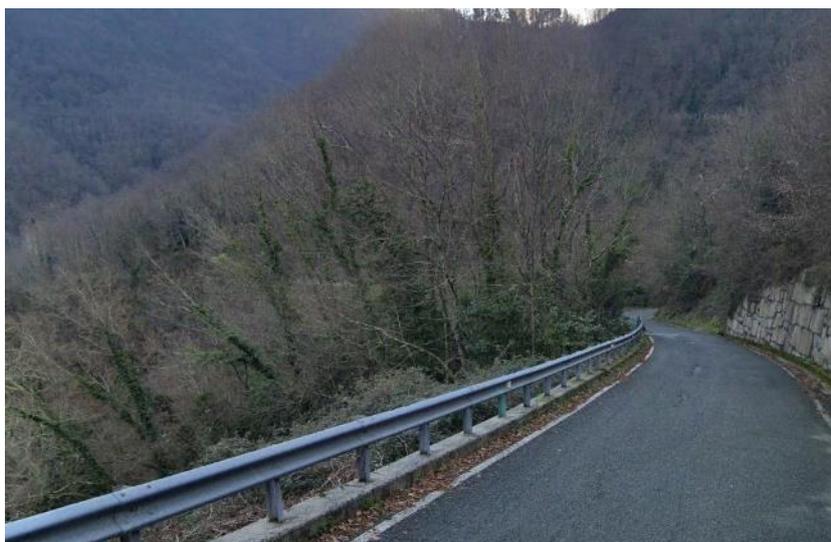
Alberi inclinati sul lato sinistro del muro.
